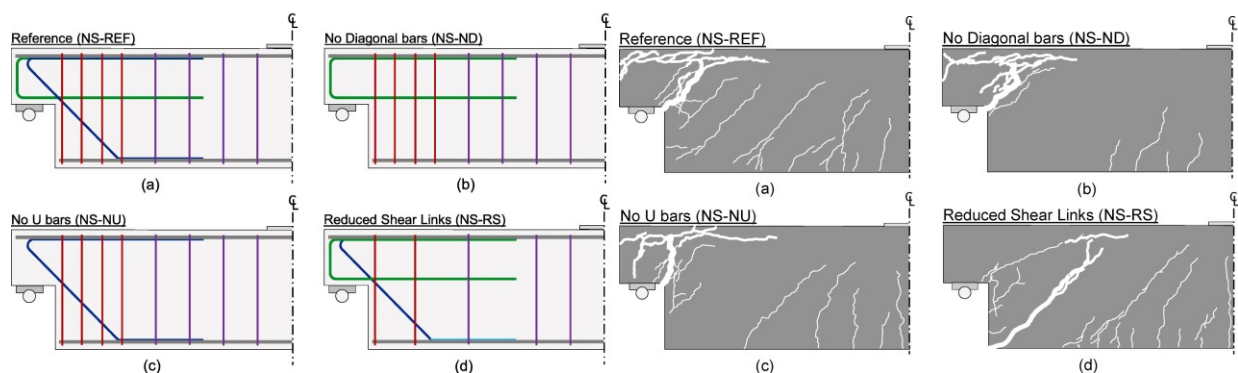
Schéma des armatures de poutres Gerber testées et les fissures associées [54]
